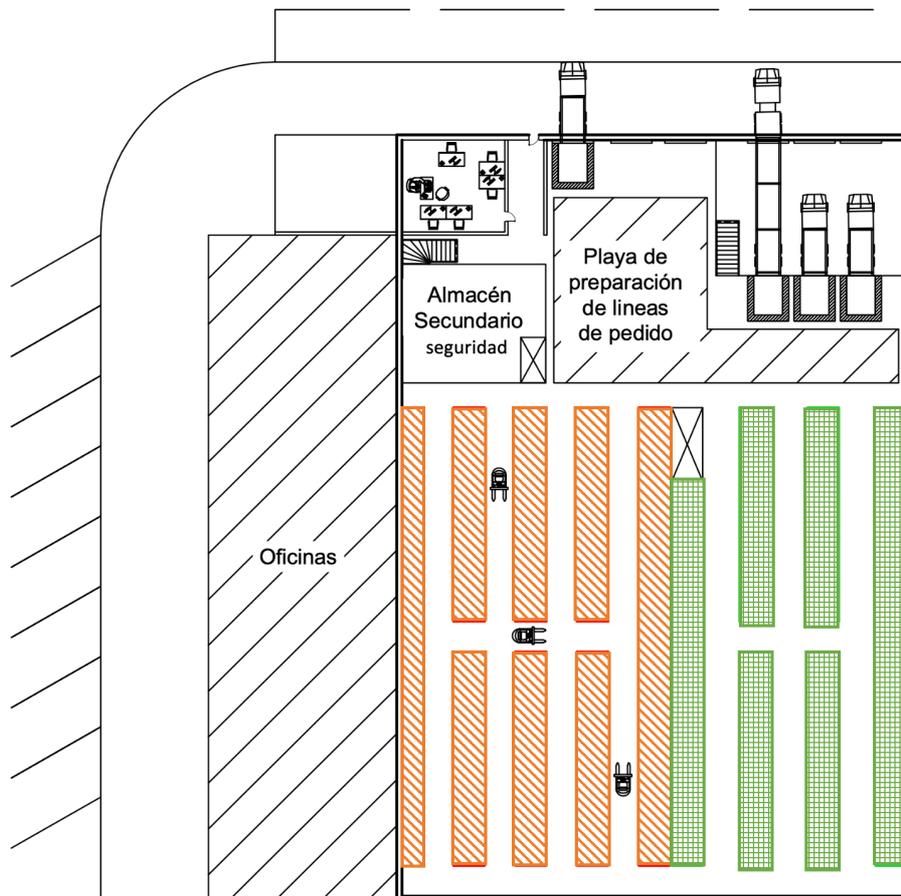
Layout planta principal. Fuente: Elaboración propia.
